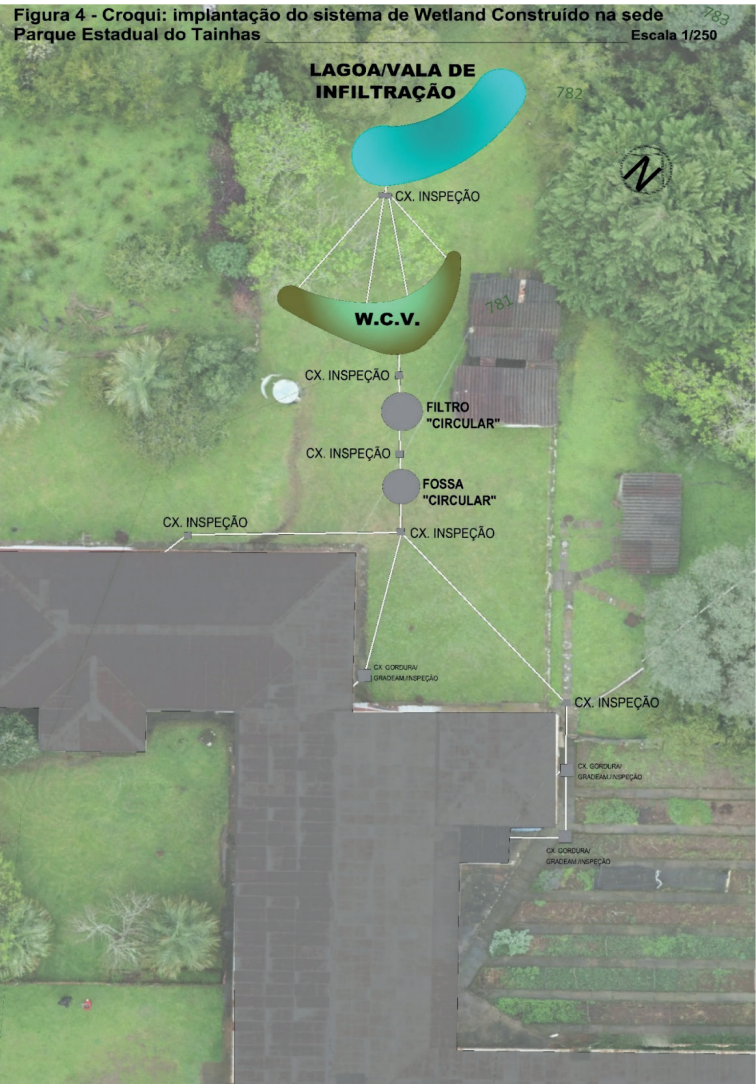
Croqui disposição do sistema sanitário da sede do PET na escala 1/250.
